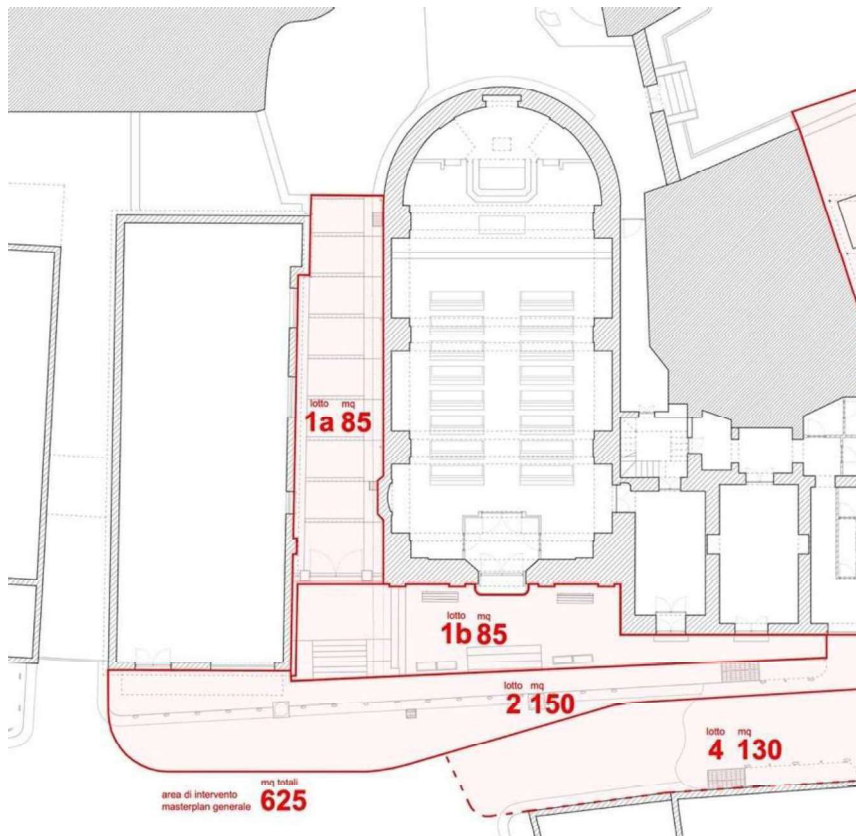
Schema identificazione lotti di intervento – progetto masterplan generale
